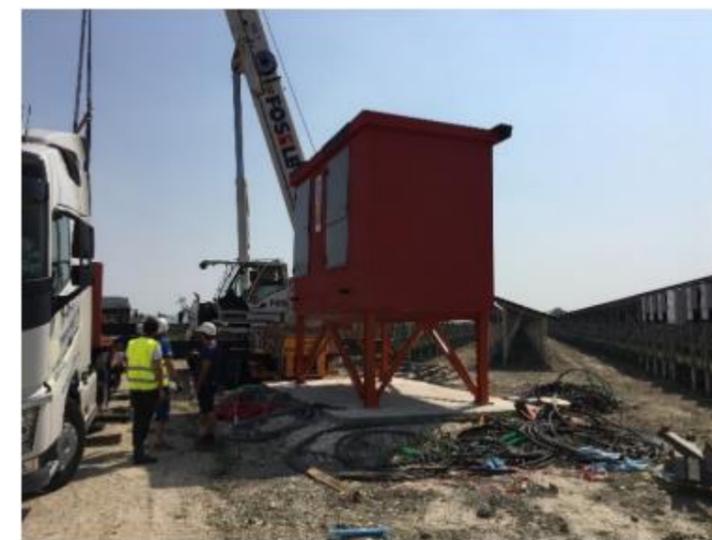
Illustration de l'installation d'un local technique (source : URBASOLAR, 2021)
